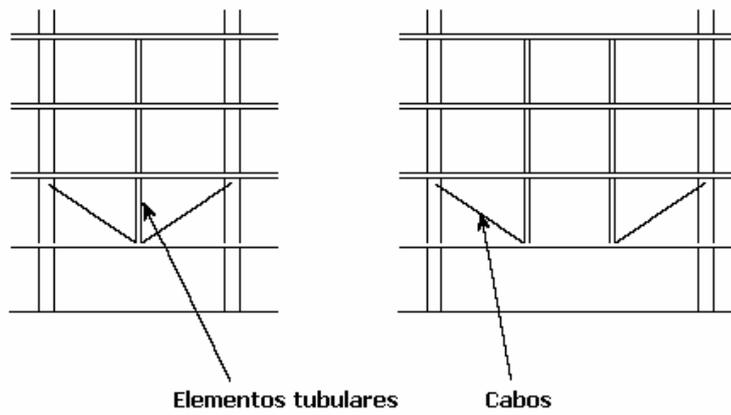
Sistemas de contraventamento para revestimentos de fachadas
